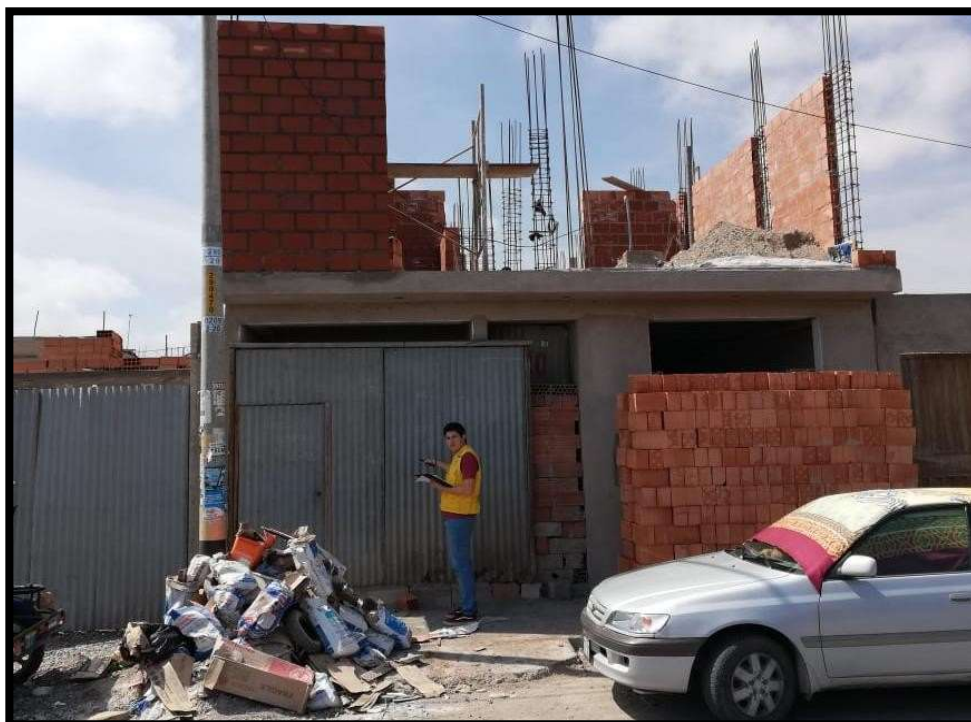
Construcción de Vivienda Unifamiliar de 2 pisos.
